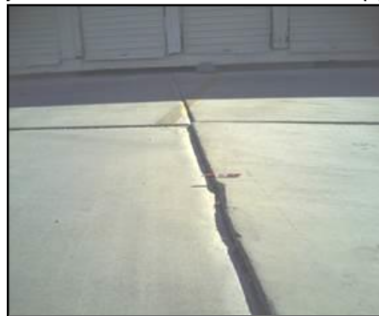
Esquema Escalonamiento entre Calzada y Juntas- Pavimento Rígido
